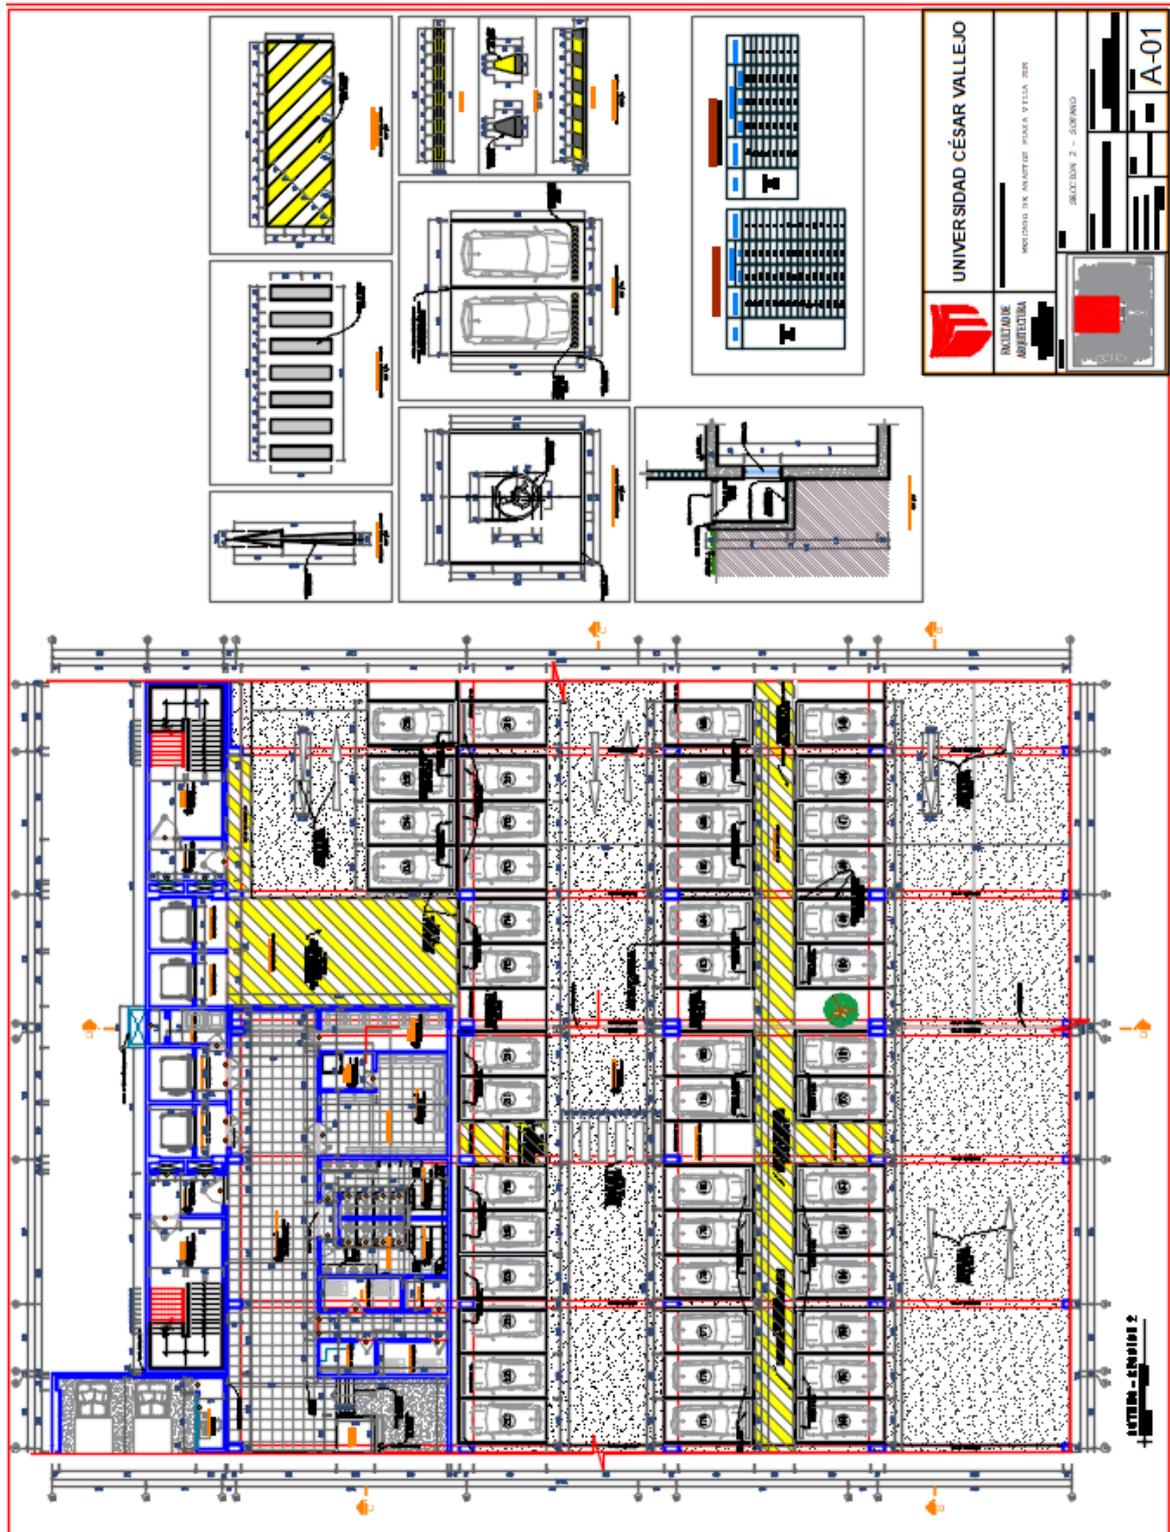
Plano de Arquitectura – Plano de secciones - sótano
